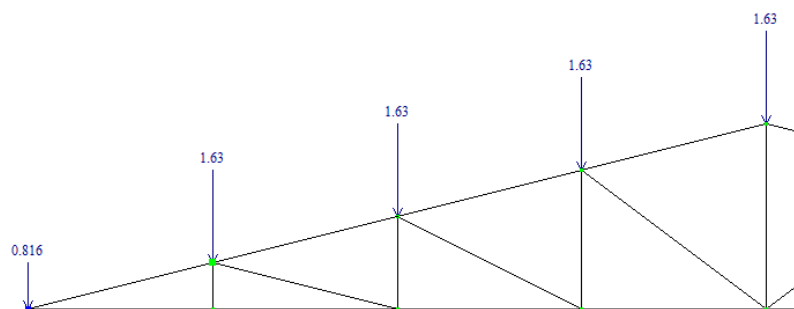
Нагрузки от веса конструкций покрытия, кН
